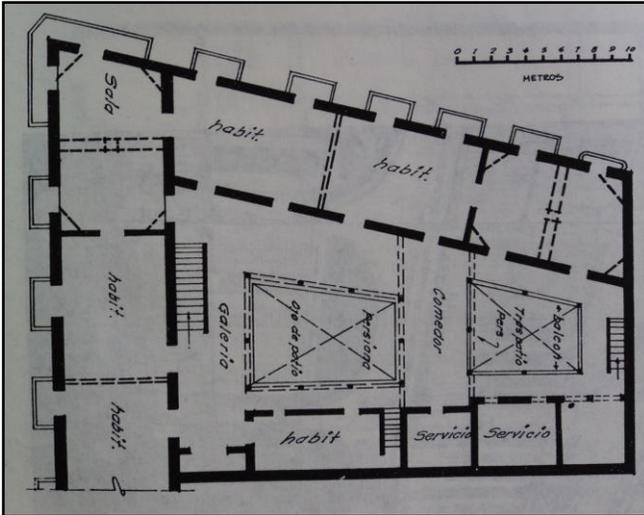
Planta de Vivienda con Escalera. Fuente: La arquitectura colonial Cubana: siglos XVI-XVII. Weis (1985).
